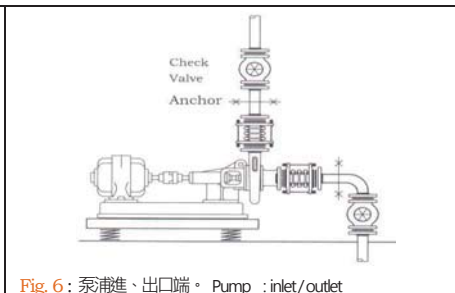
泵浦進、出口端。 Pump : inlet/outlet
